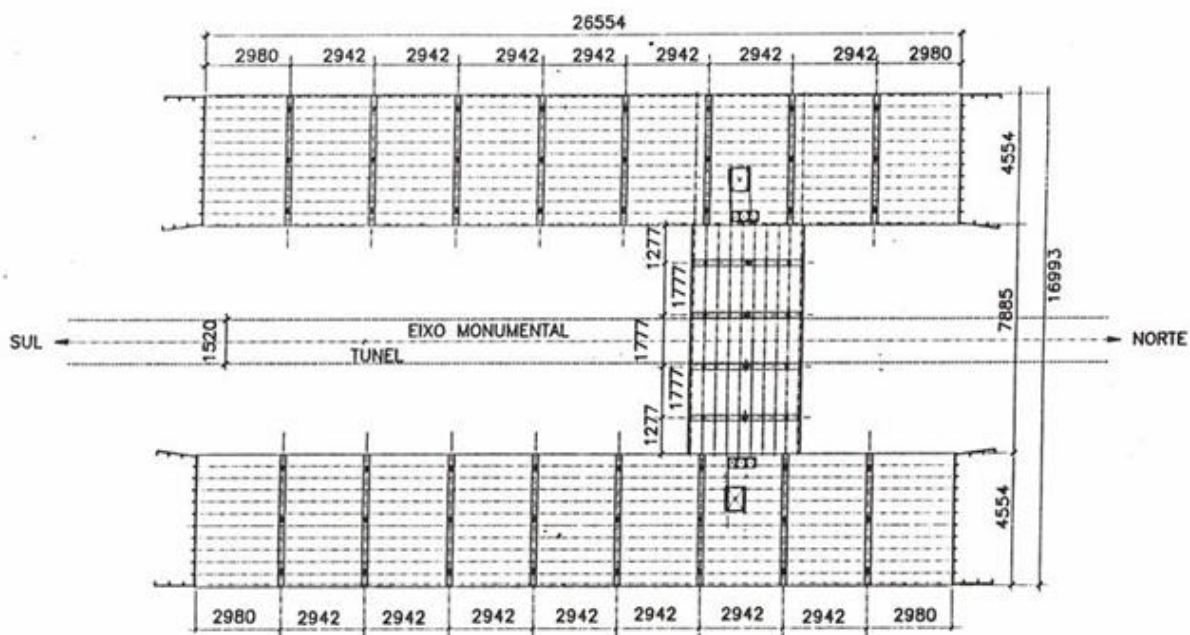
Planta Estrutural da Plataforma Superior. Fonte: Arquivo Público do DF
